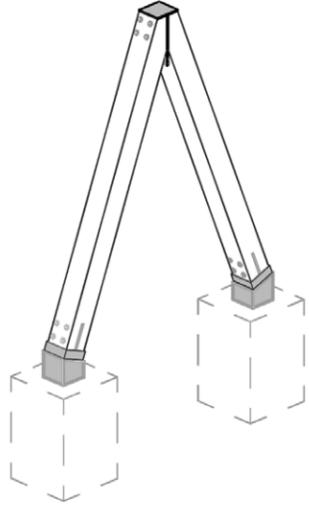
Corte fugado tipo escantillón. Planimetría de elaboración propia.
